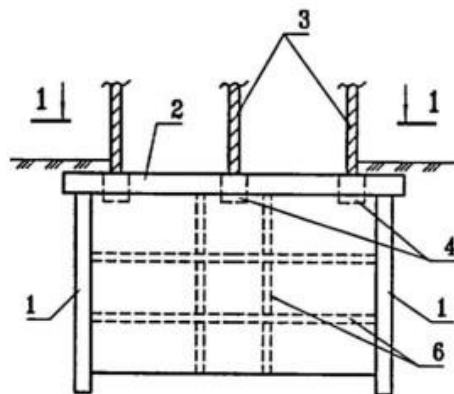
Схема влаштування підземного поверху 1 – стіни підземної споруди; 2 – залізобетонна несуча плита; 3 – несучі стіни будівлі; 4 – фундаменти; 6 – конструкції підземних поверхів
